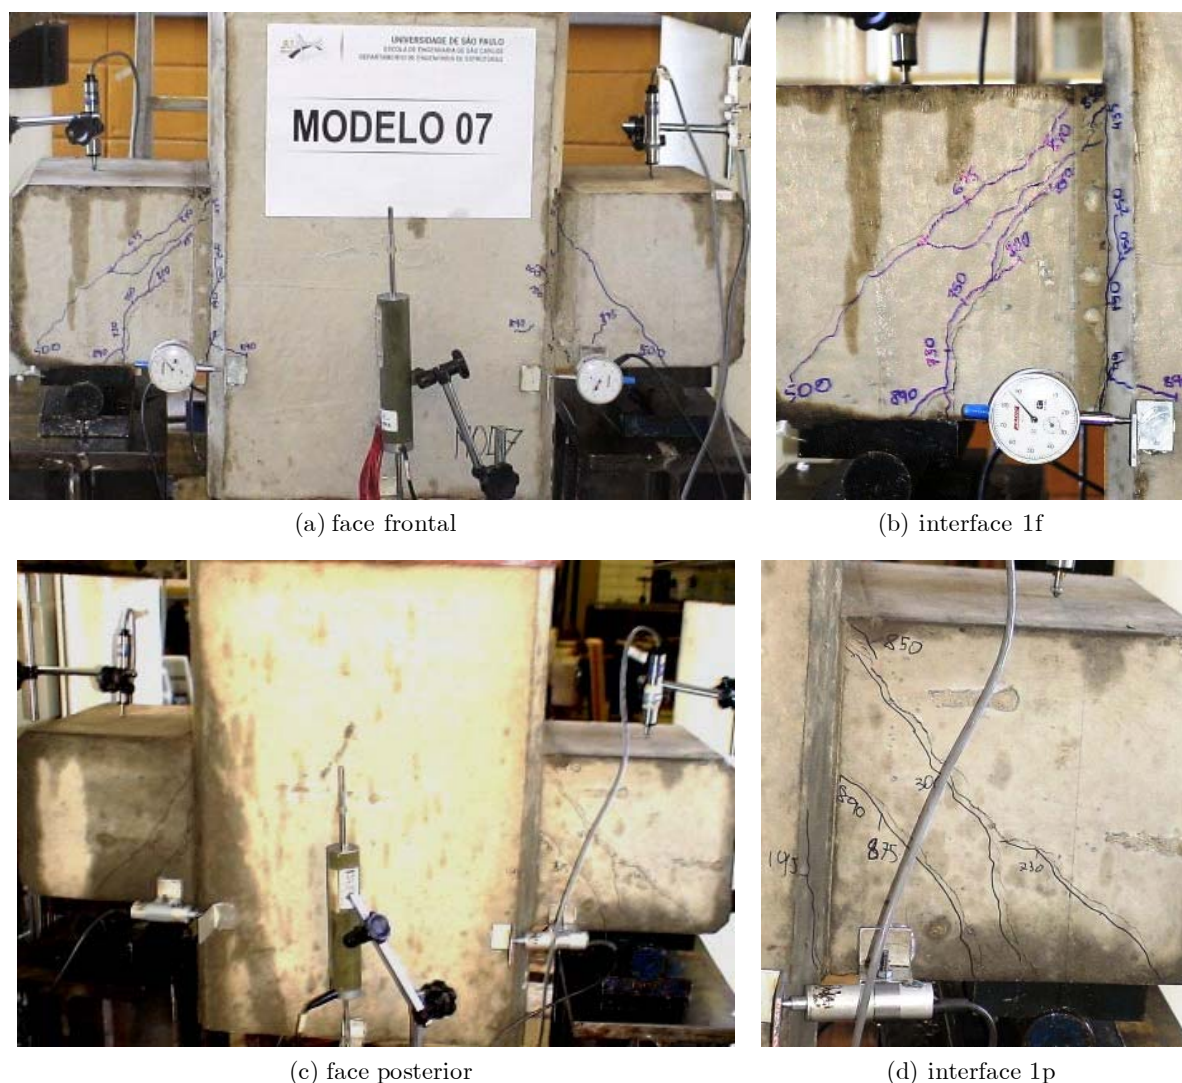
Quadro de fissuração do modelo MRC7.
